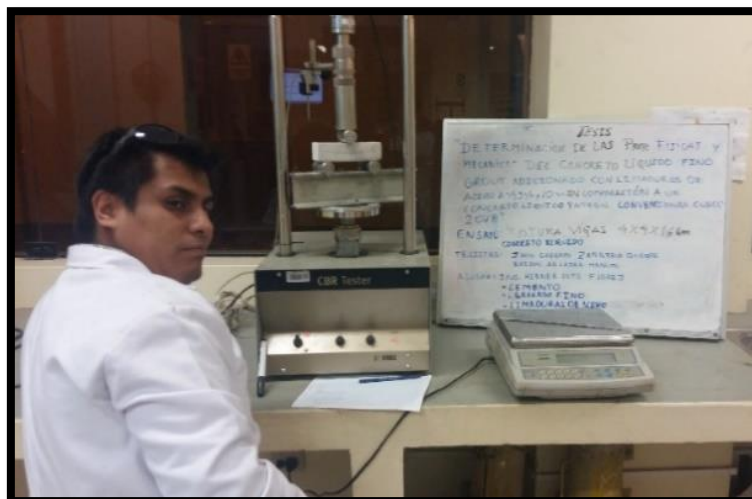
Prueba de flexión de la vigueta usando la máquina CBR.
